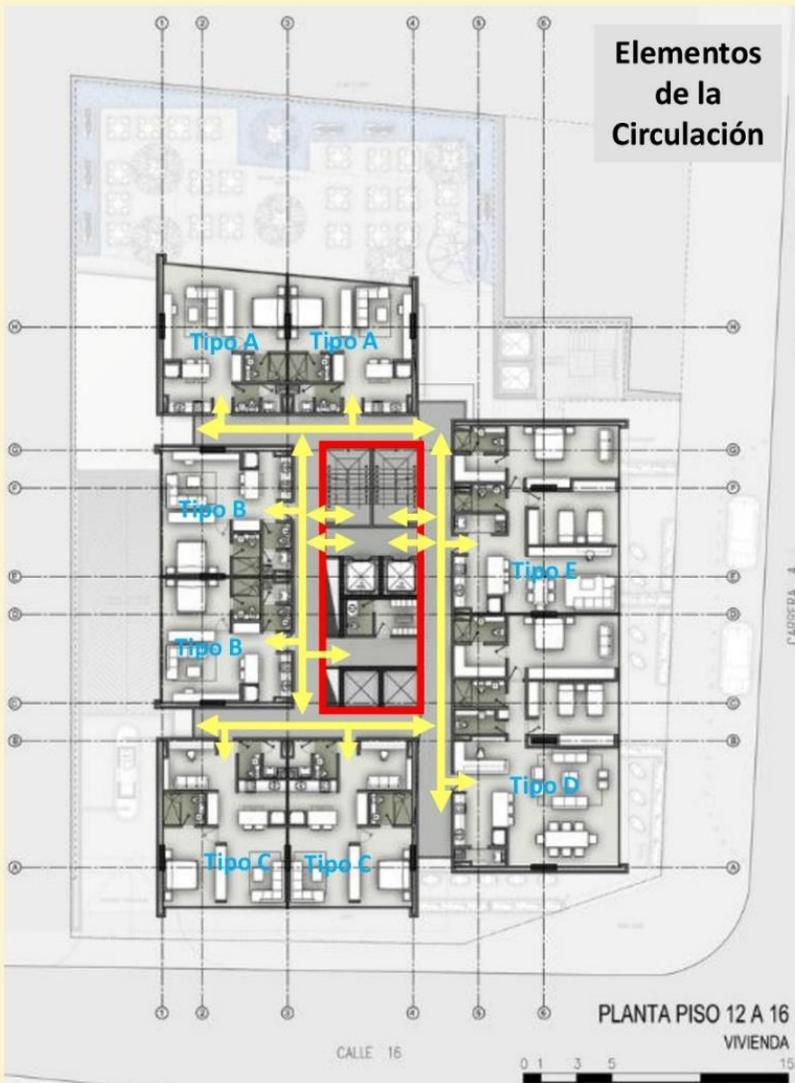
Piso modelo de viviendas escala 1:300 Fuente: www.archdaily.pe
